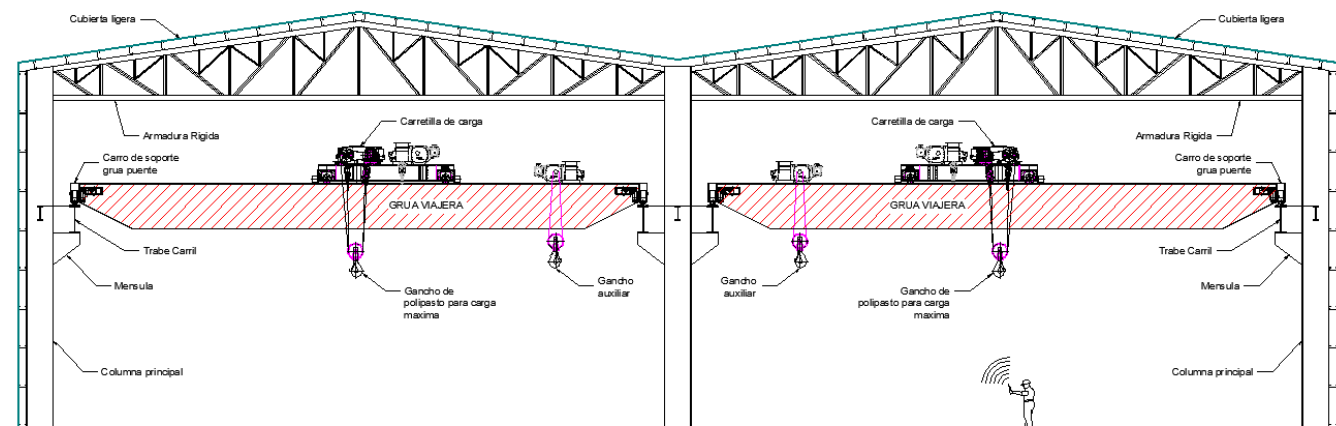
Estructura principal en dos crujeas a base de columnas de concreto o acero con apoyo de ménsula para trabe carril y armadura rígida de acero a dos aguas para la cubierta.
